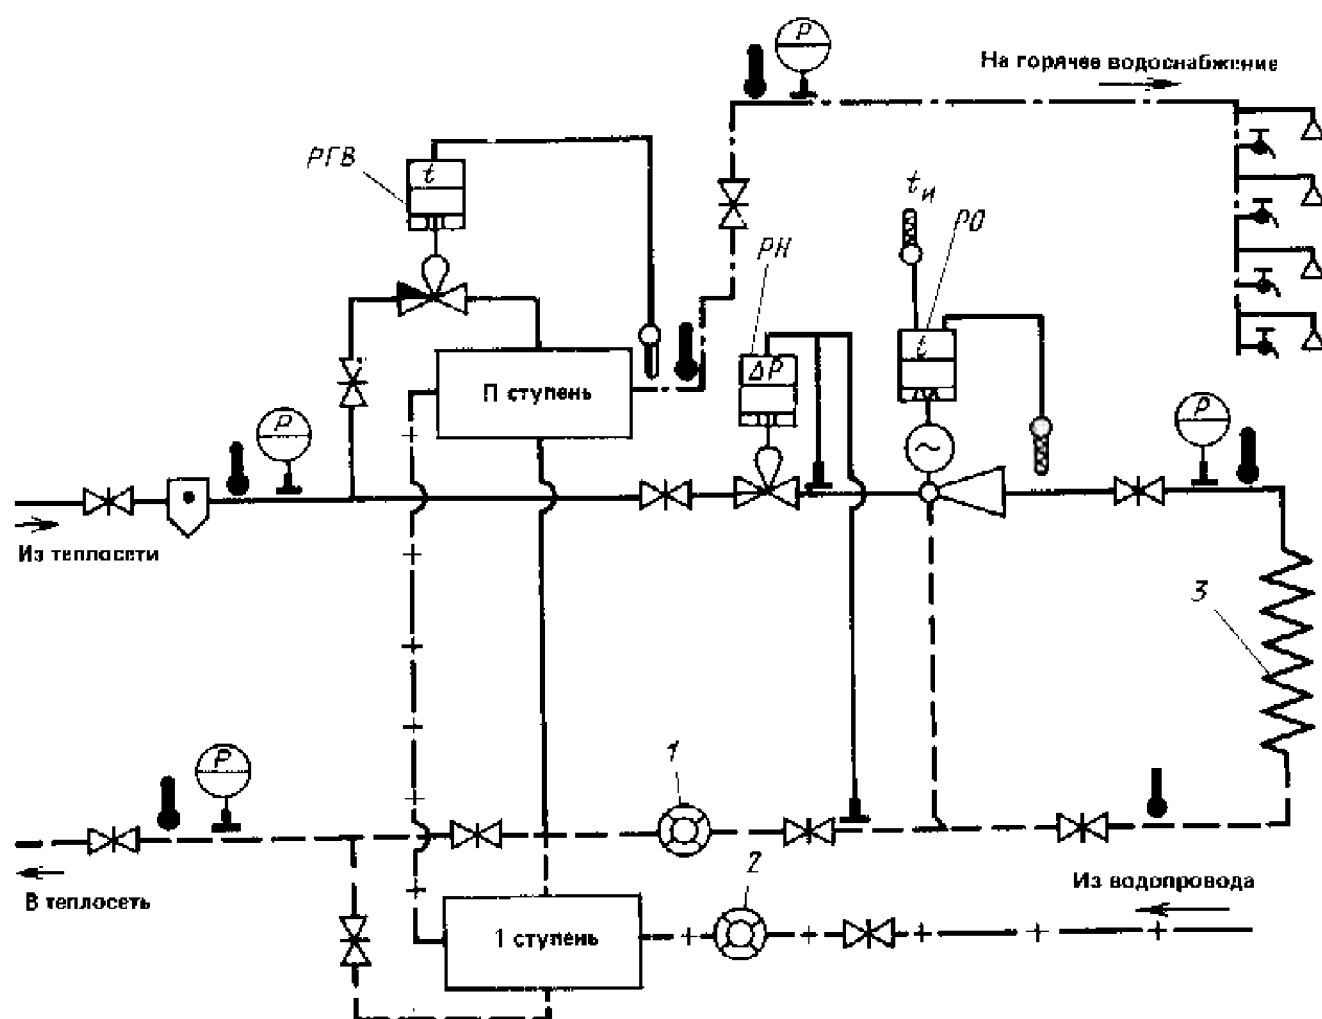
Схема ИТП с элеваторным присоединением системы отопления
